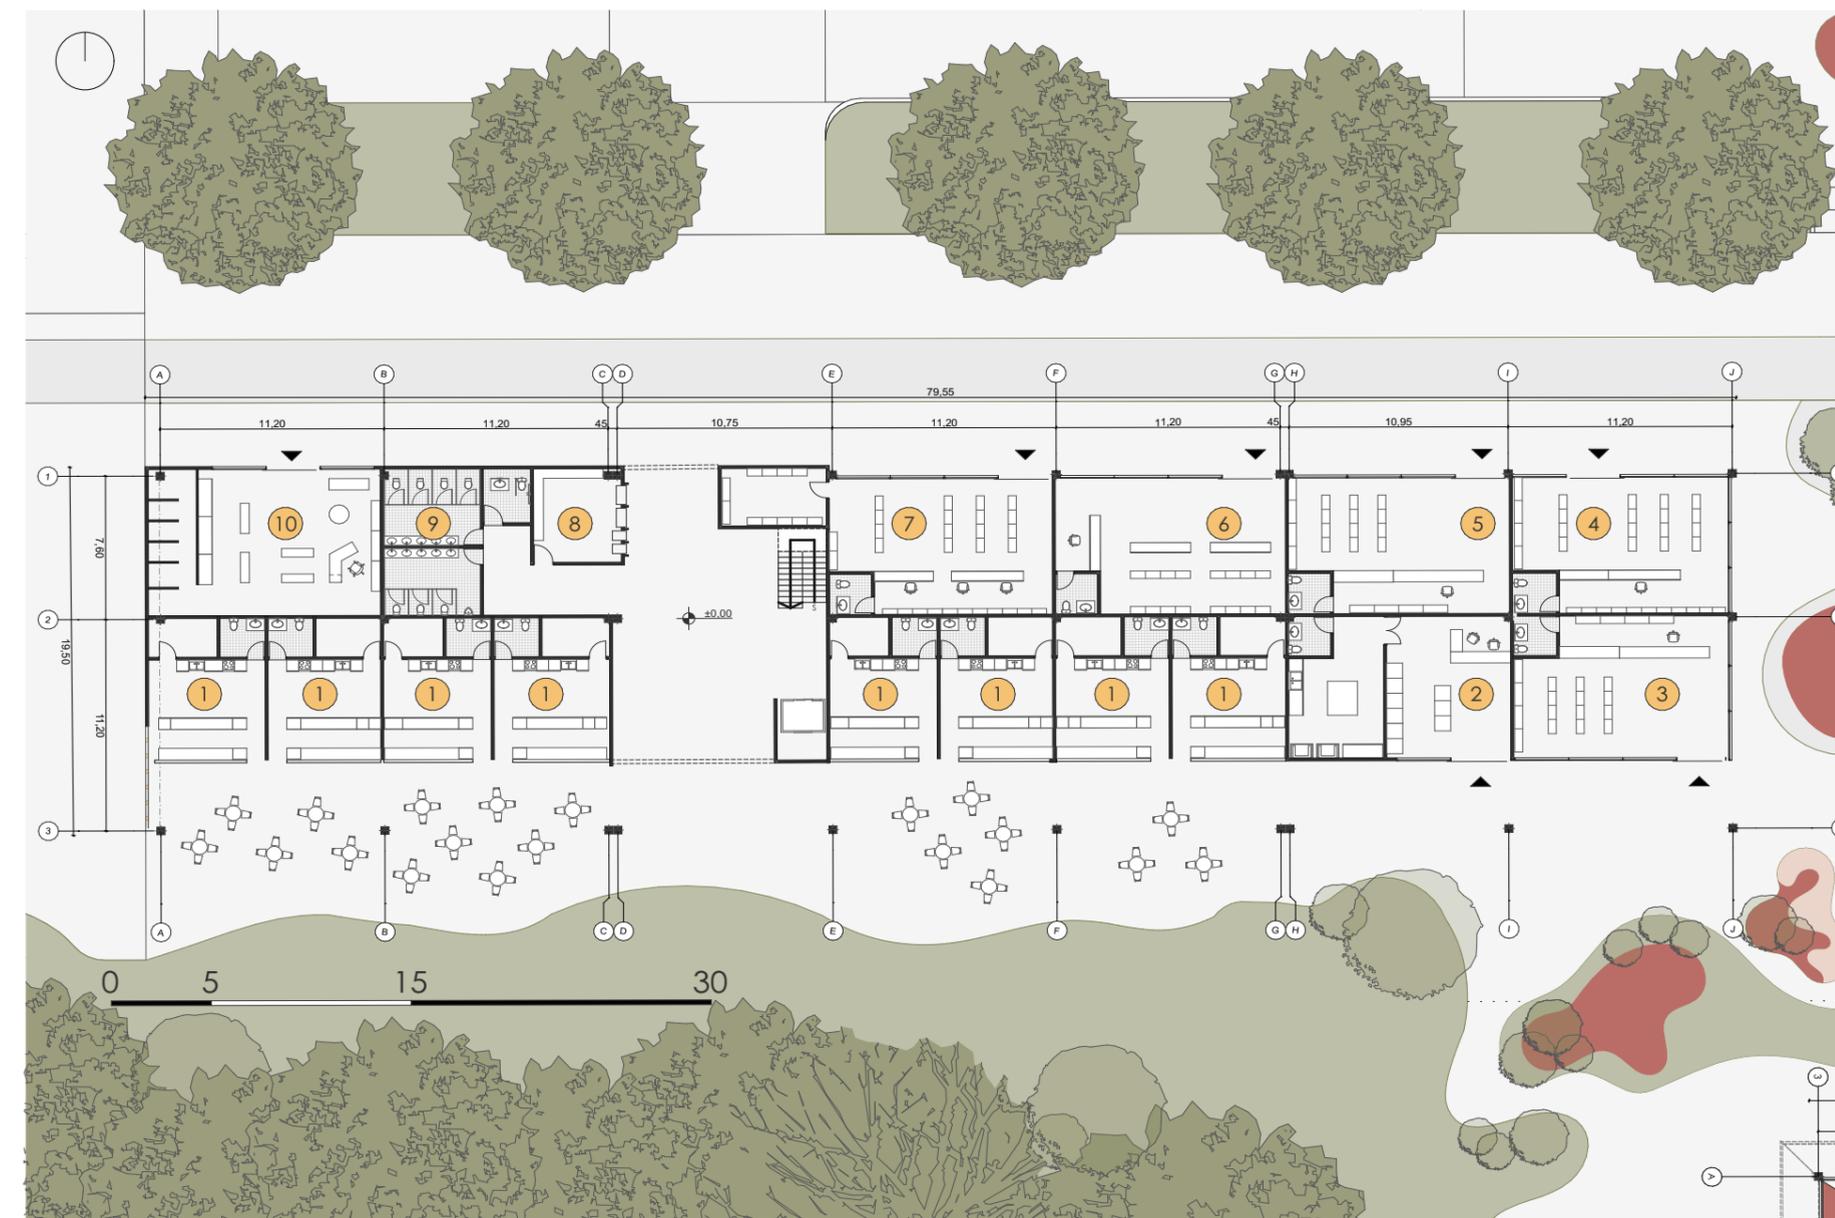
Planta baja bloque comercial Fuente: Propia, 2022
